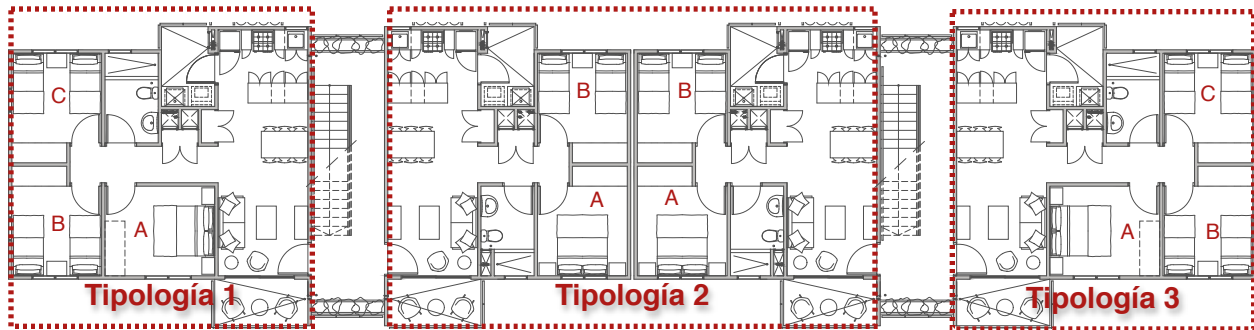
Planta Tipo, La Barquita, Santo Domingo.
